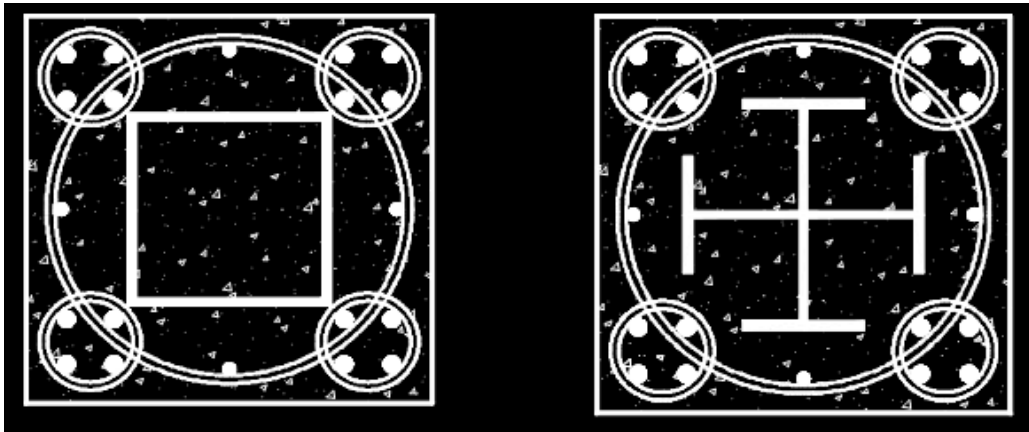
Secciones transversales de dos columnas SRC con sistema multi-esprial [34]
